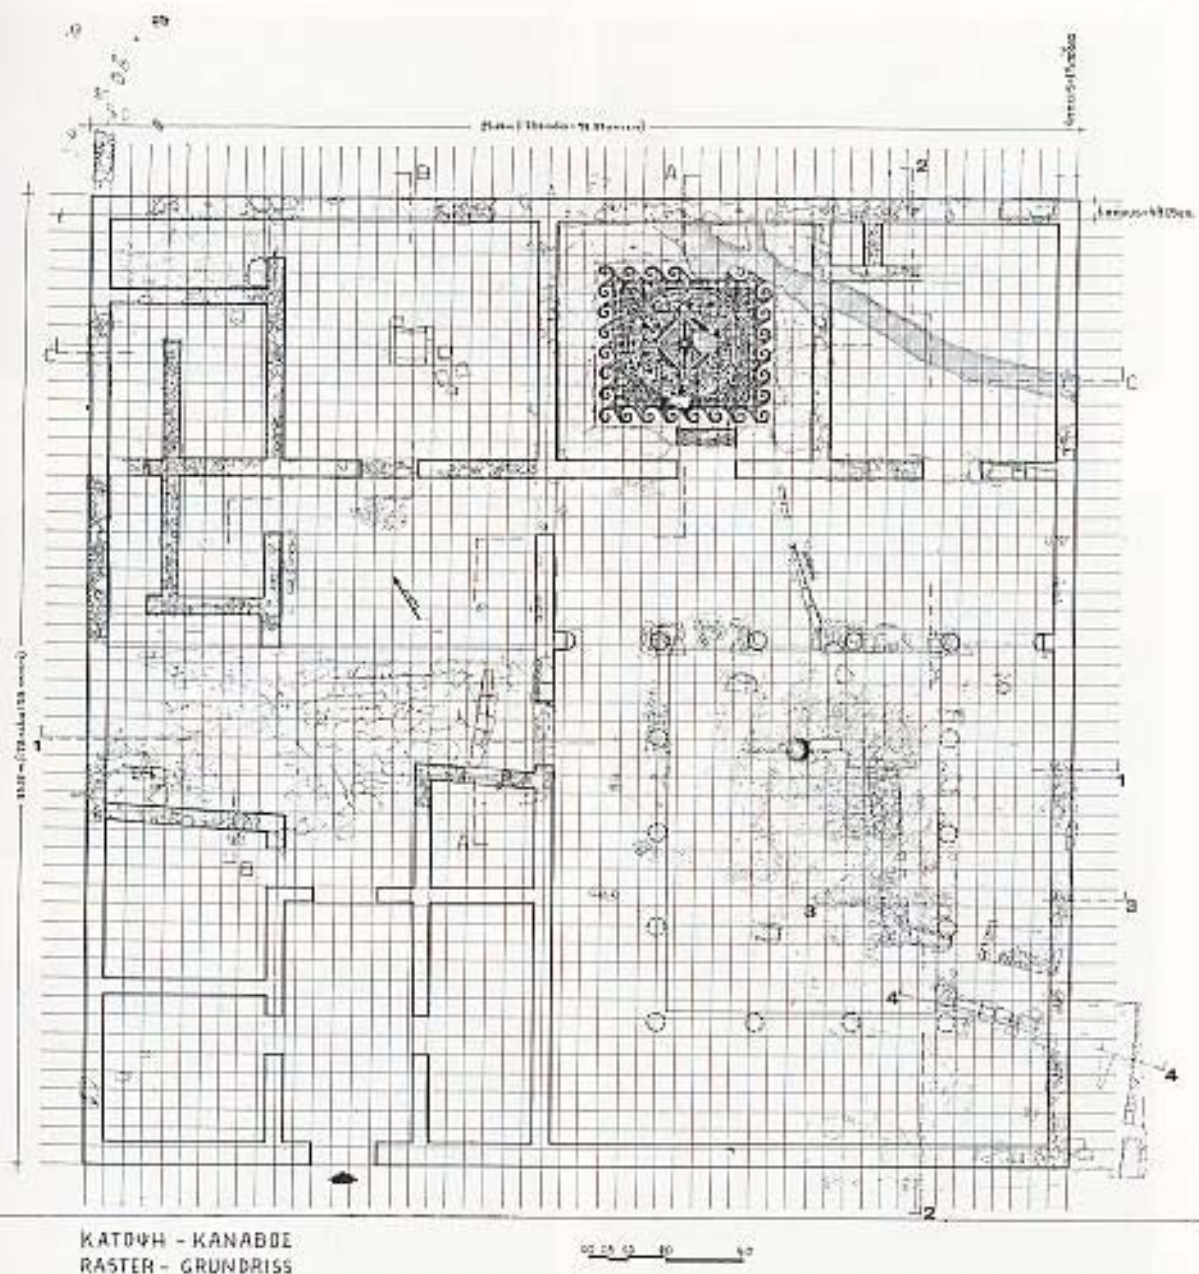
Spätclassisches Haus, Grundriß mit Rastereinheit 1 dorische Elle, M. 1:200
